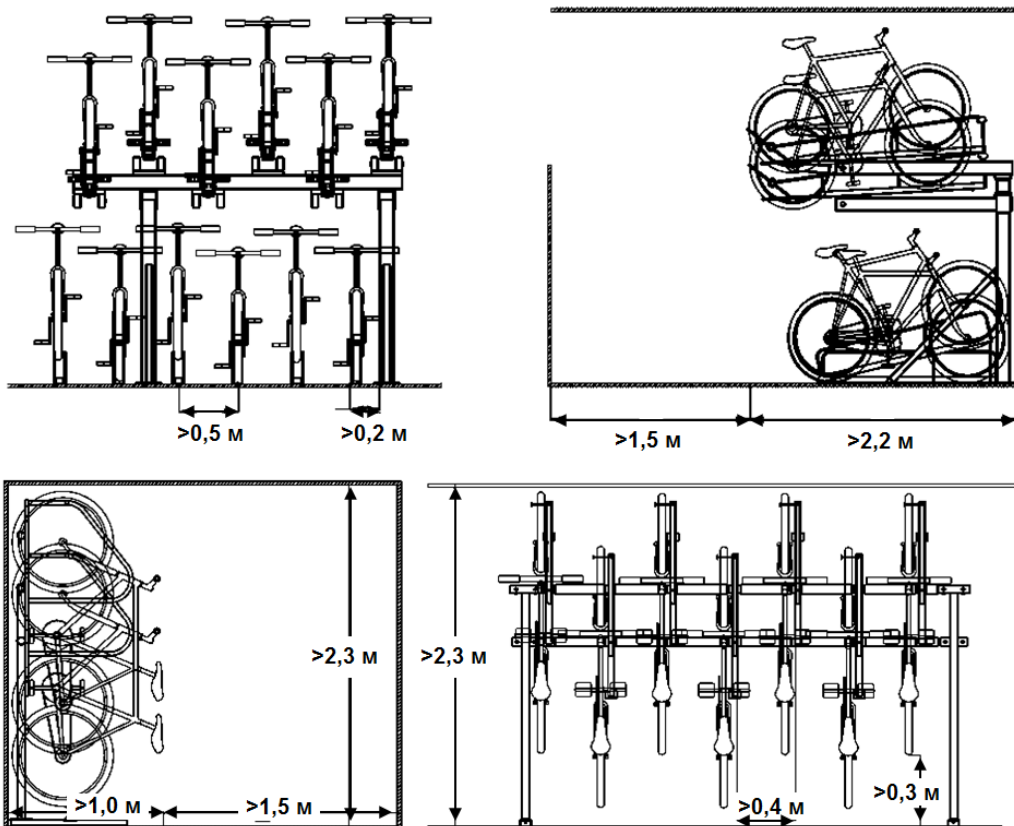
Размещение велосипедов на двухъярусных горизонтальных и вертикальных кронштейнах
